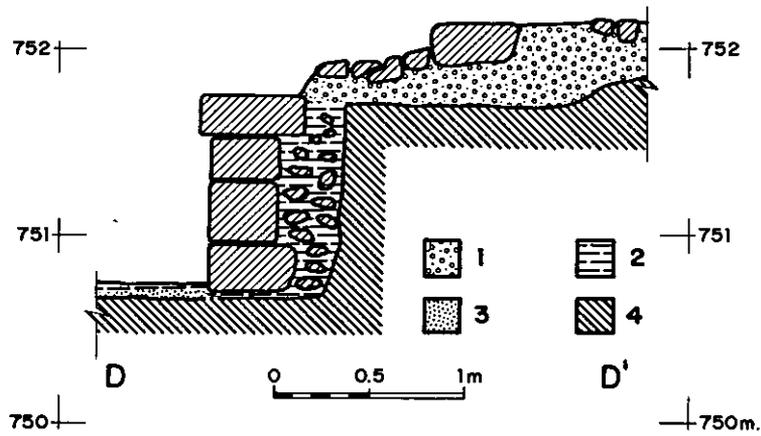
Sección por D-D' de las figuras 15 a 17. 1: pavimento; 2: arcilla de impermeabilización; 3: arena de granito con arcilla del fondo del Estanque; 4: roca natural.
